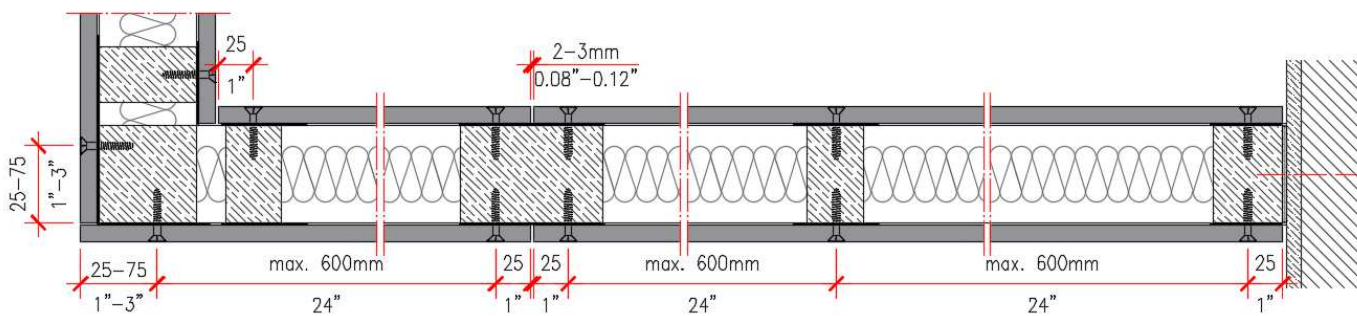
Secção horizontal da parede, estrutura de madeira
